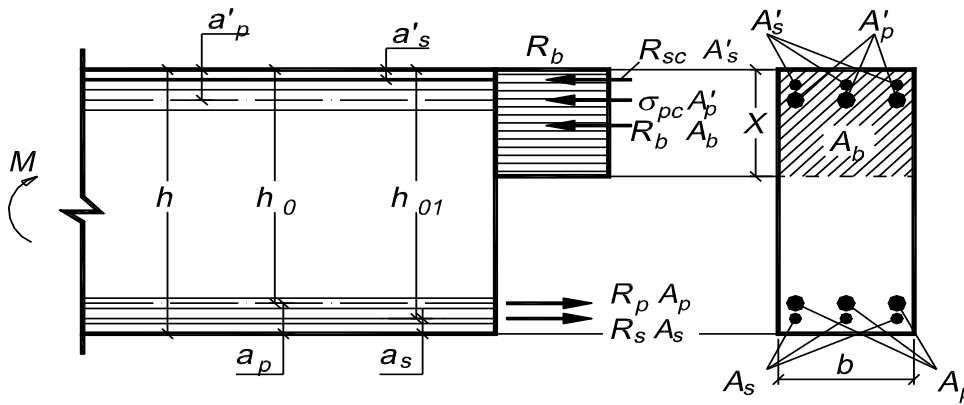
Схема зусиль і еюра напружень у перерізі, нормальному до поздовжньої осі залізобетонного згинаного елемента при розрахунку його міцності
